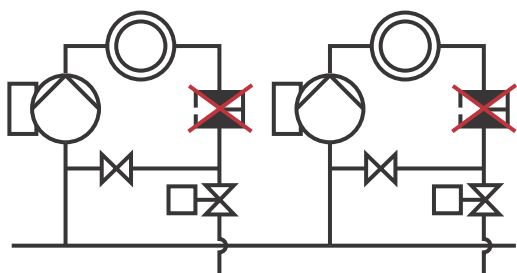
Mindre behov for en pumpeindreguleringsventil
